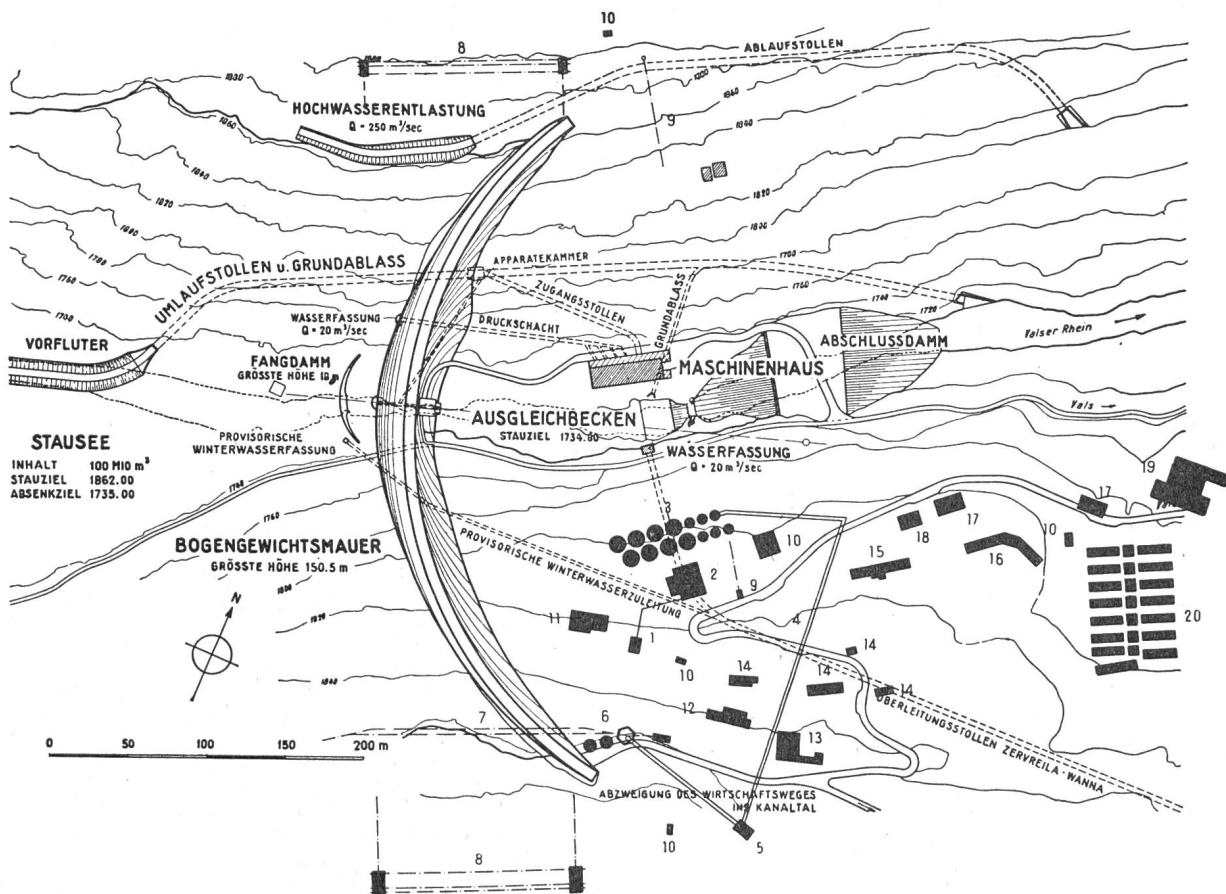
Lageplan 1:5000 mit Staumauer, Maschinenhaus und Ausgleichbecken Zervreila. Installationen zur Errichtung der Mauer:
